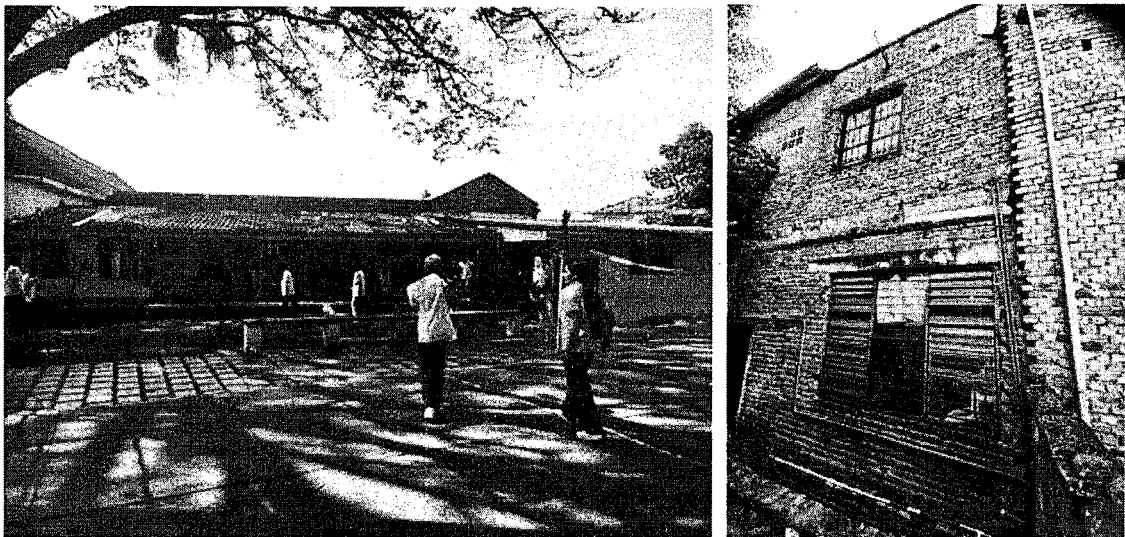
Fotos patio posterior y fachada oeste con junta de empate adición Momento 3, BIC
